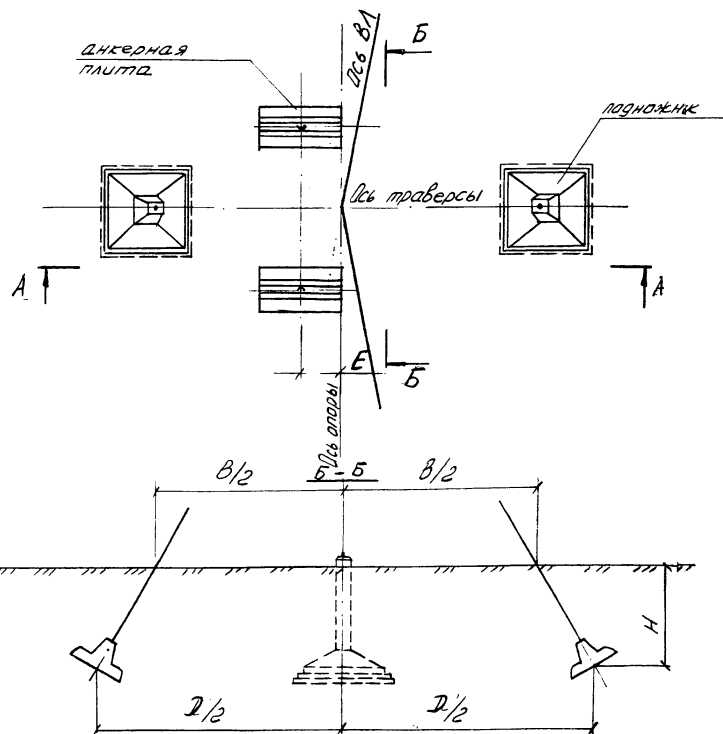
Схема фундаментов под промежуточно-уловную опору ПУБ-5.
